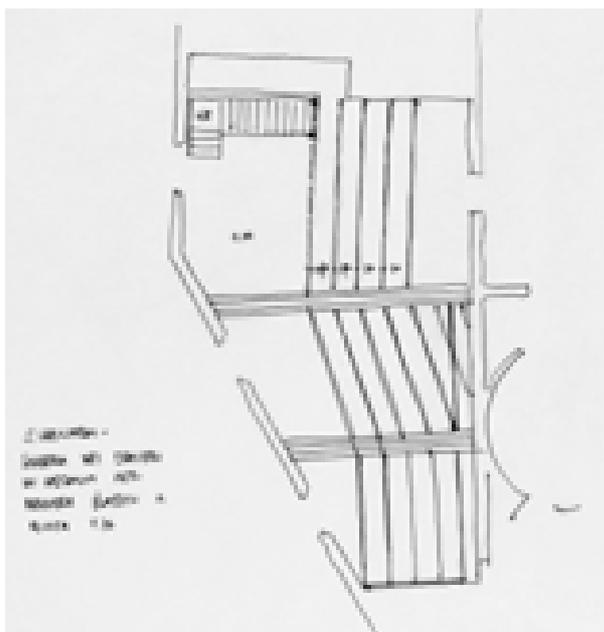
Studio disposizione travetti castagno per reggere assito +2,76 – s.d. (AABS-94.181)
